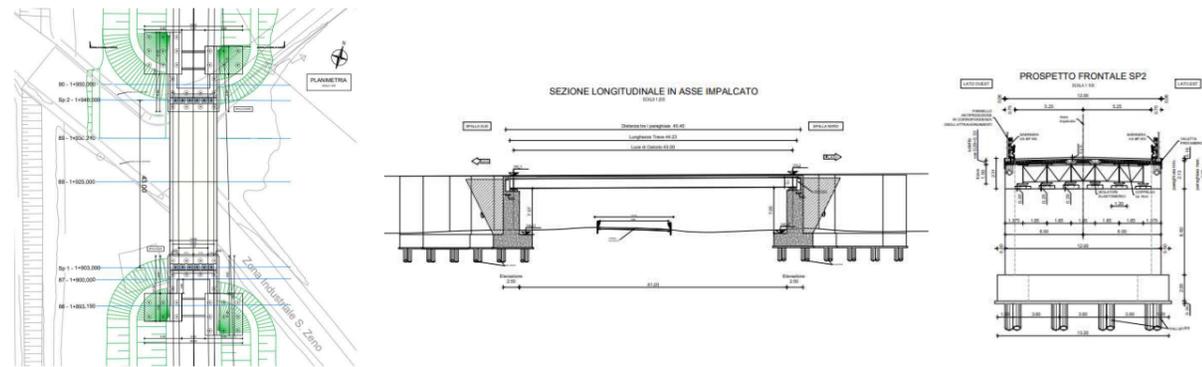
Pianta, profilo e sezione del Ponte San Zeno
